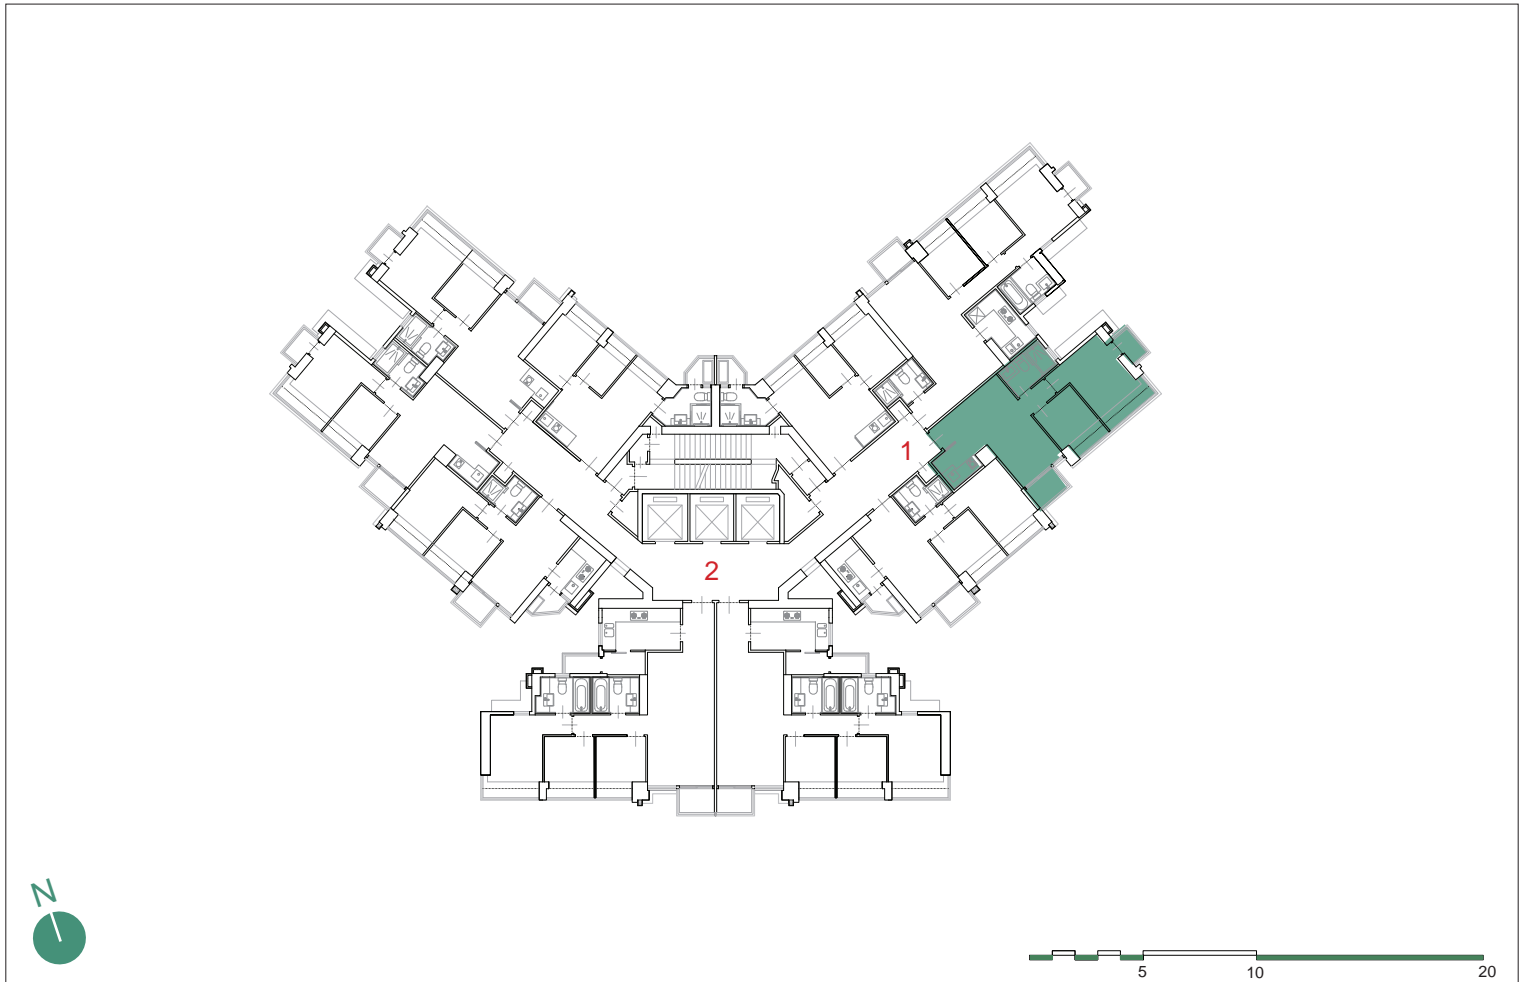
Grundrissplan - Regelgeschoss OG 20 - The Reach
